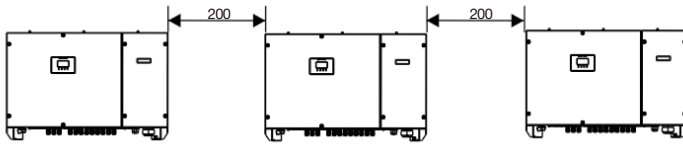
Installazione lungo la stessa linea (unità: mm)
